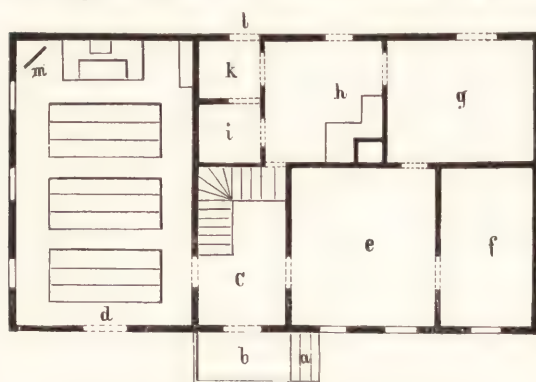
Grundriss des preussischen Schulhauses.
